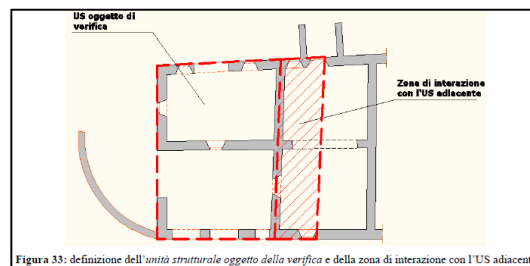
definizione dell'unità strutturale oggetto della verifica e della zona di interazione con l'US adiacente
